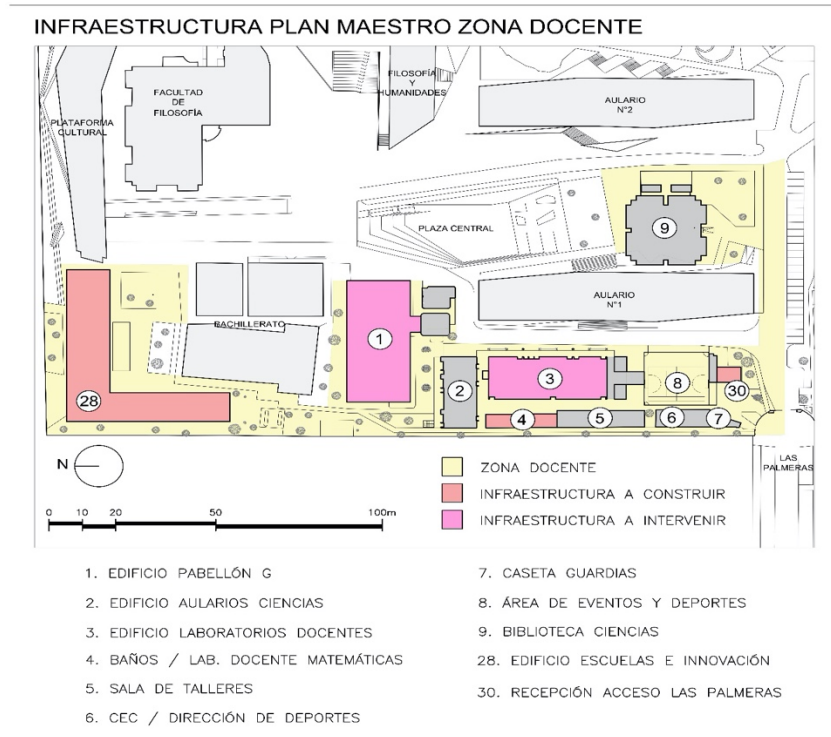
Plano Propuesta para la Infraestructura Zona Docente
